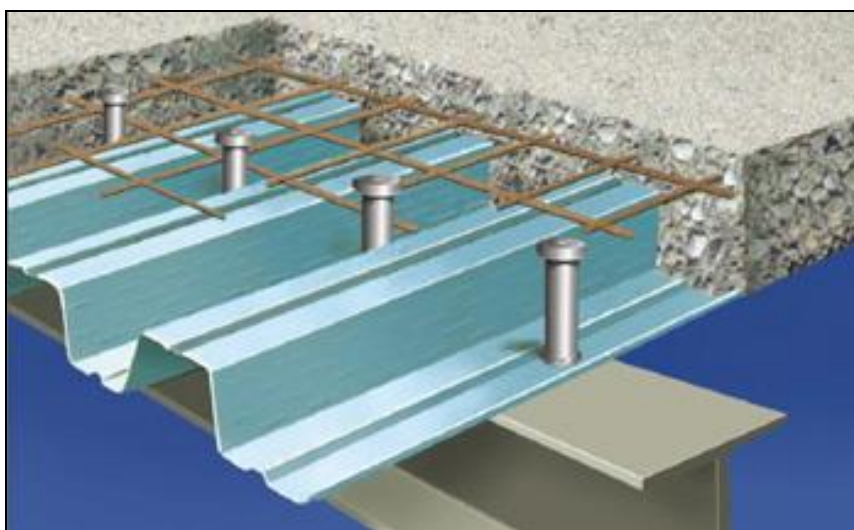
Corte transversal da estrutura utilizada na montagem do *steel deck*.
